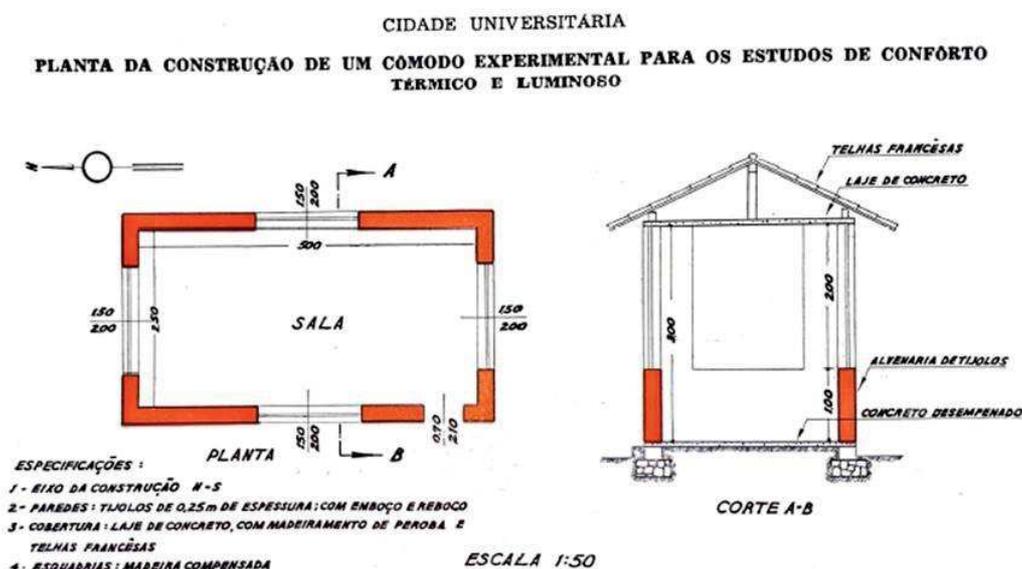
Planta de construção da “casa experimental” (SÁ, 1951).
